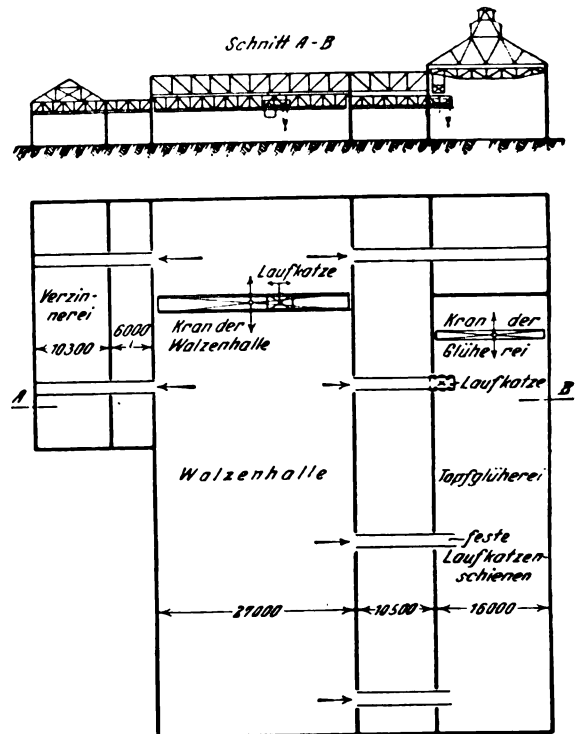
Lageplan eines Hallenkranes mit ausfahrbarer Führerstands-laufkatze.
